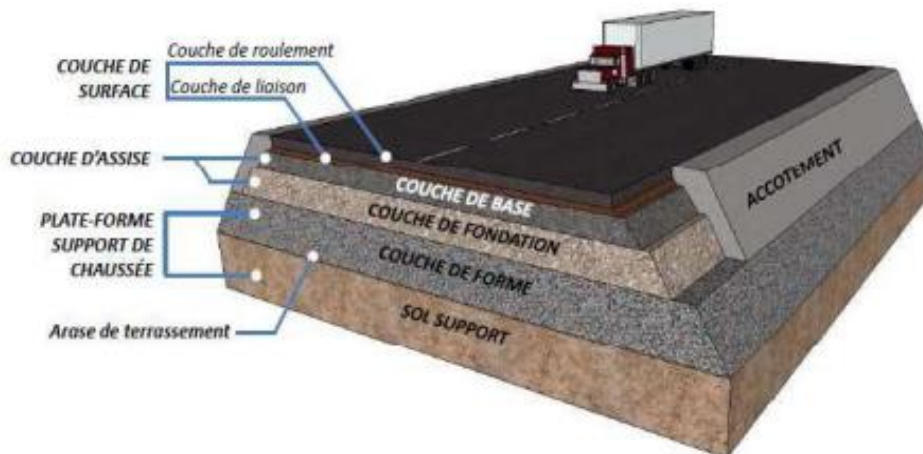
Différentes couches d'une chaussée revêtue [4]
